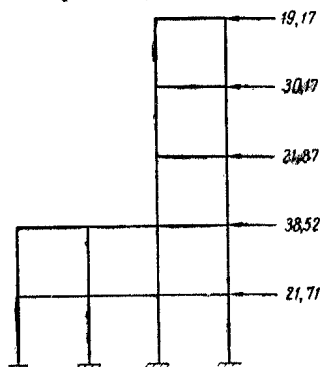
Расчетная ветровая нагрузка на блок этажерки
